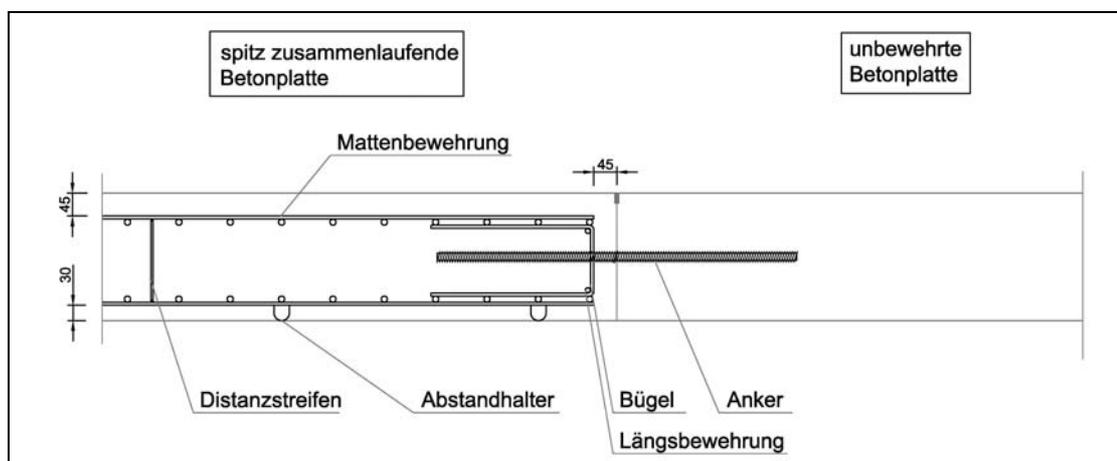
Lage der Bewehrung in der spitz zusammenlaufenden Betonplatte [15].
